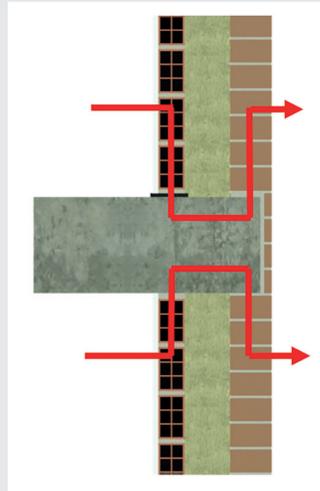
Fachada autoportante STRUCTURA-GHAS.
